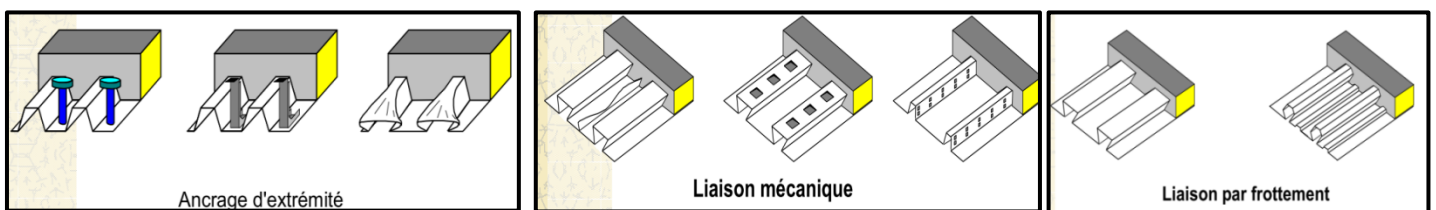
une dalle coulée in situ sur un platelage (tôle profilées en acier formées à froid)
